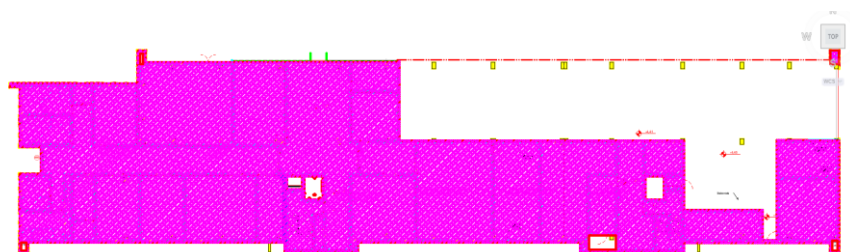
Áreas consideradas para o pavimento em contato com a fundação (Subsolo)
